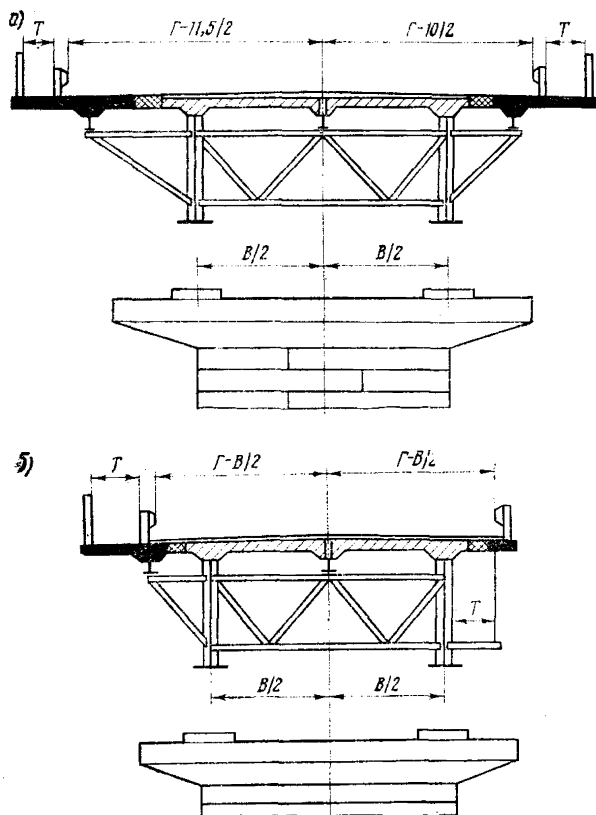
Схемы уширения сталежелезобетонных пролетных строений со сплошной стенкой до габаритов Г-10, Г-11,5 (а) и Г-8 (б) за счет добетонирования плиты и устройства дополнительных прогонов
